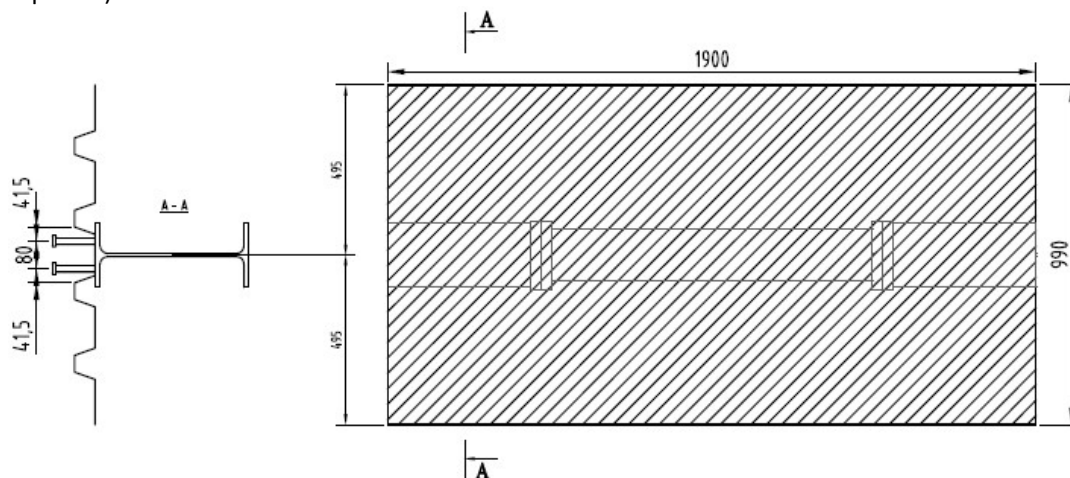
Placa din beton pentru linkurile cu placa de capat extinsa.
